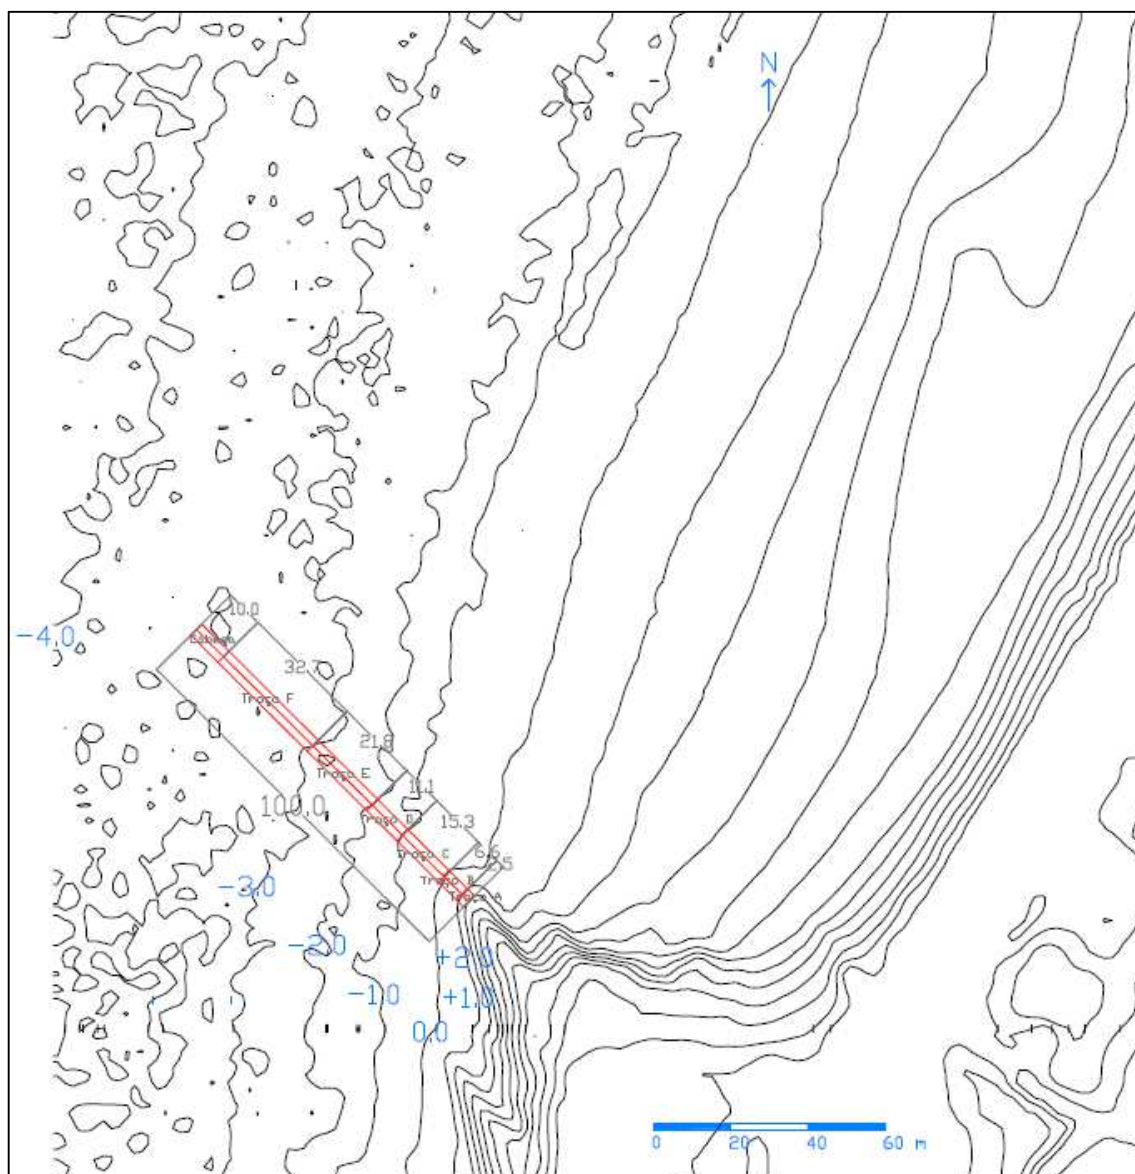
Planta de implantação de esporão em “L” para a hipótese de 100 m de comprimento
